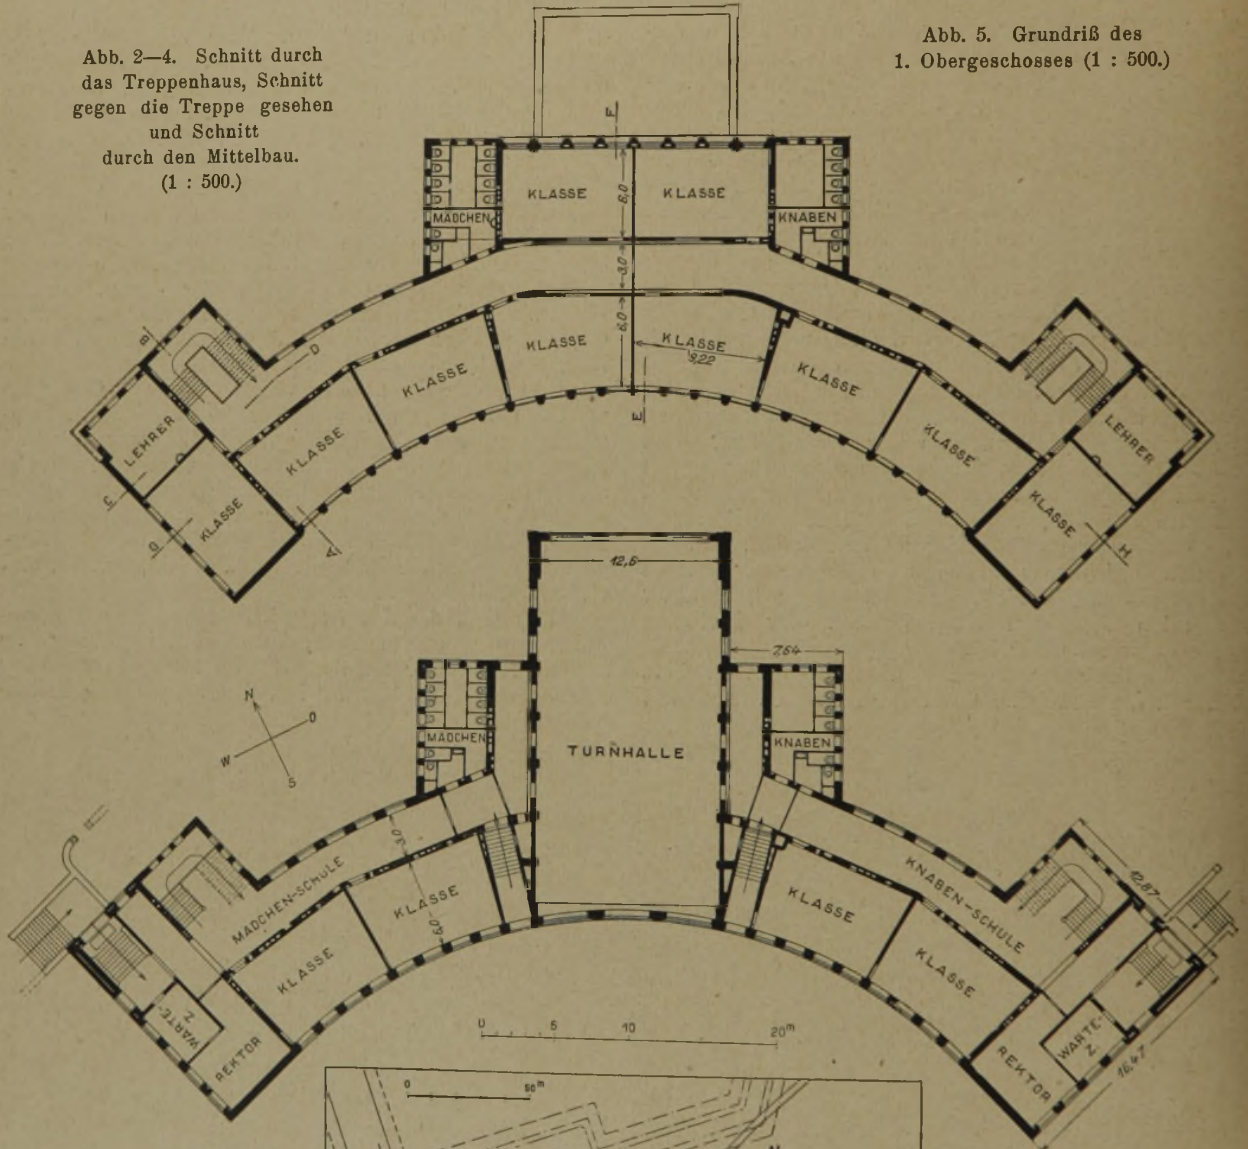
(oben). Grundriß des Erdgeschosses. (1 : 500.)
